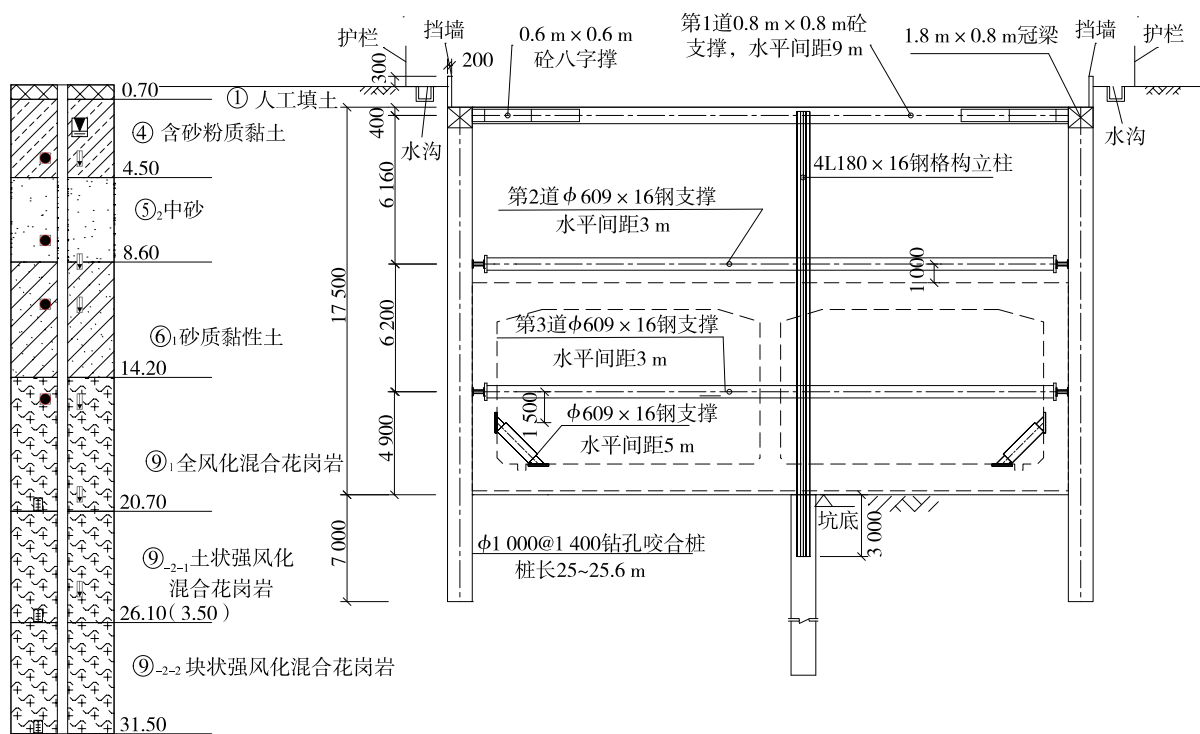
工程地质状况和基坑围护结构断面图(单位:标高为m,其他为mm)
